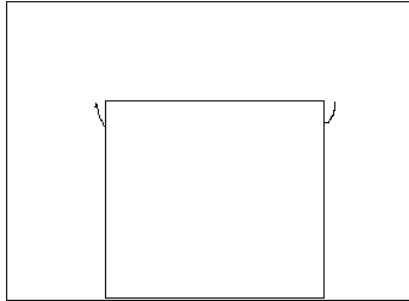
Fisura por apoyo escaso del dintel lo cual provocó una carga puntual elevada. Los dinteles deben apoyar al menos 25 cm en muros portantes y 15 cm en tabiques divisorios.
